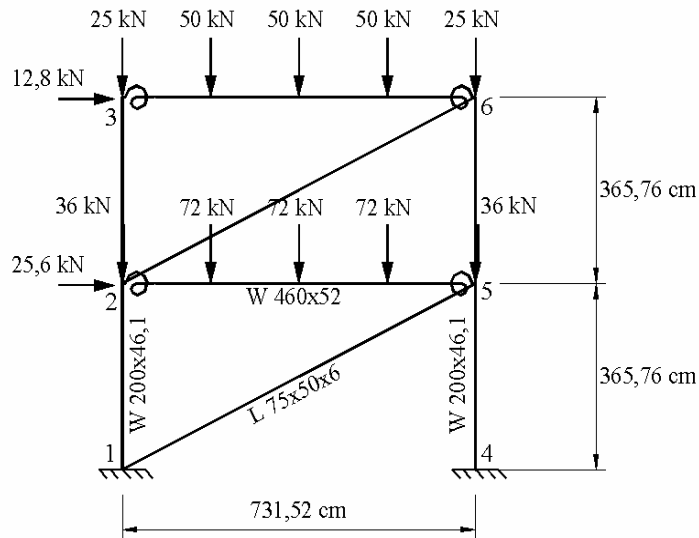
Pórtico contraventado de dois andares e um vão
